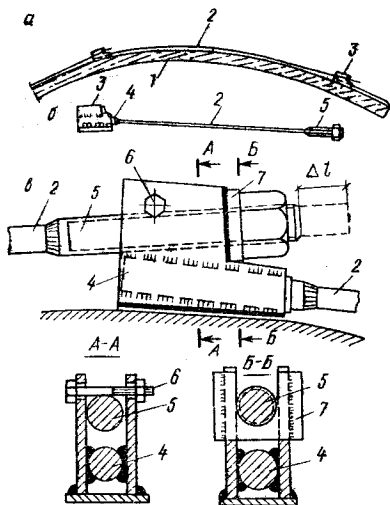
Детали стержневой напрягаемой арматуры при электротермическом способе натяжения
